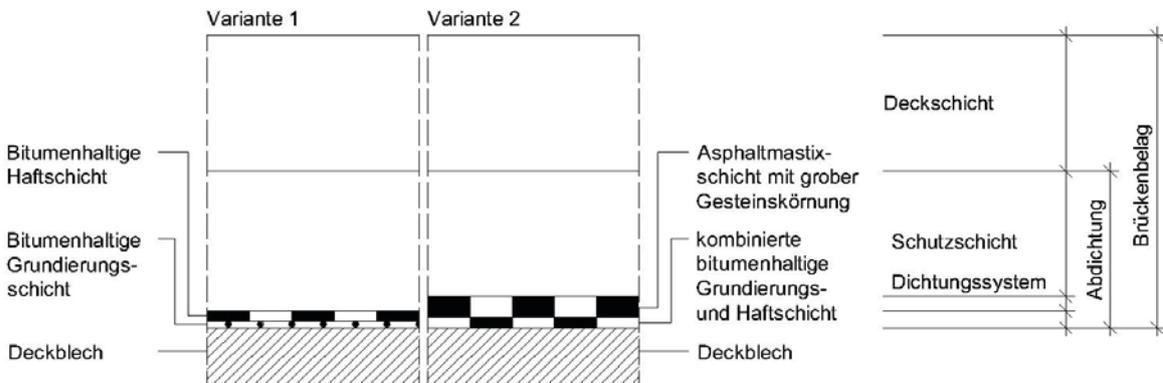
Bauart 2 mit Bitumen-Dichtungssystem
